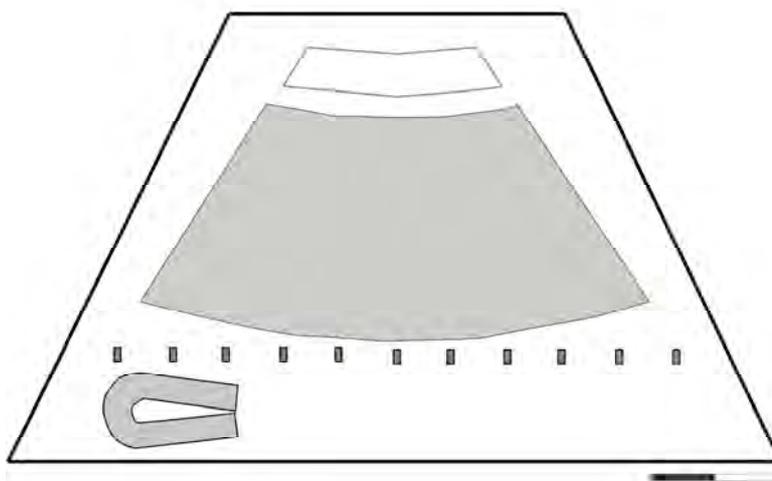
Sala Villa-Lobos. Esquema da planta baixa.
